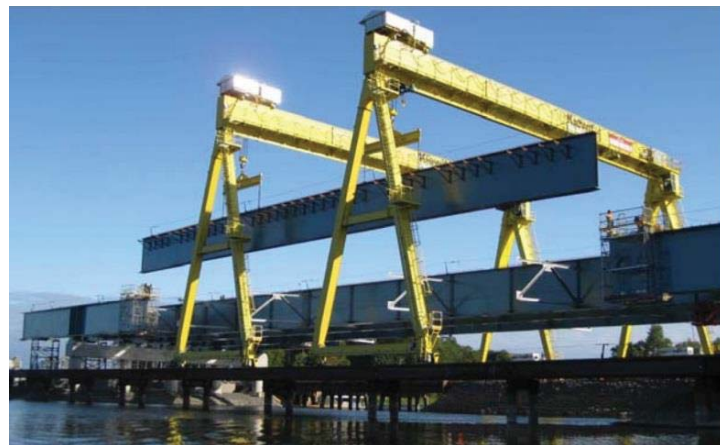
Pont de l'autoroute 25 : Deux portiques de levage circulant sur des rails
